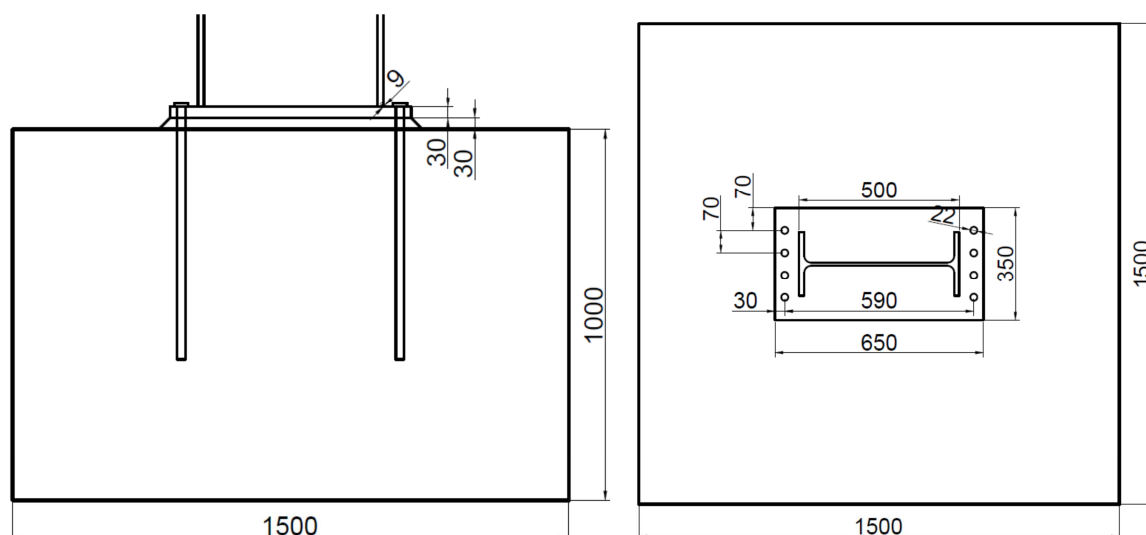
Definição geométrica da ligação do pilar 2 do pórtico 2
